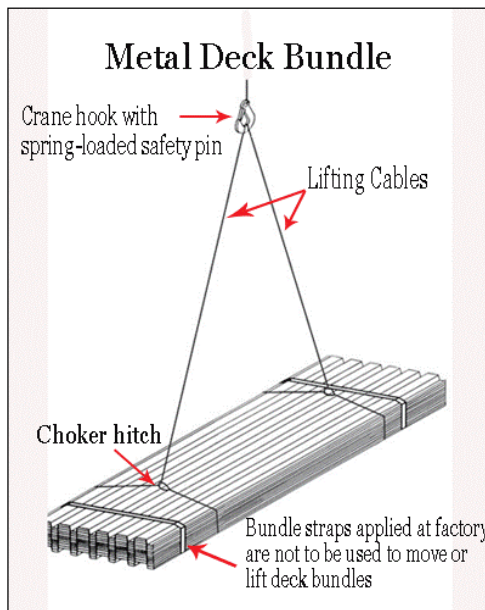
Izaje mecánico. ABBATA, Allan. WARREN. *Metal Decking Provides for Building Stability and Worker Safety*. [En línea] 17 de Enero de 2014. <https://www.warrenforensics.com/2014/01/17/metal-decking-provides-for-building-stability-and-worker-safety/>
